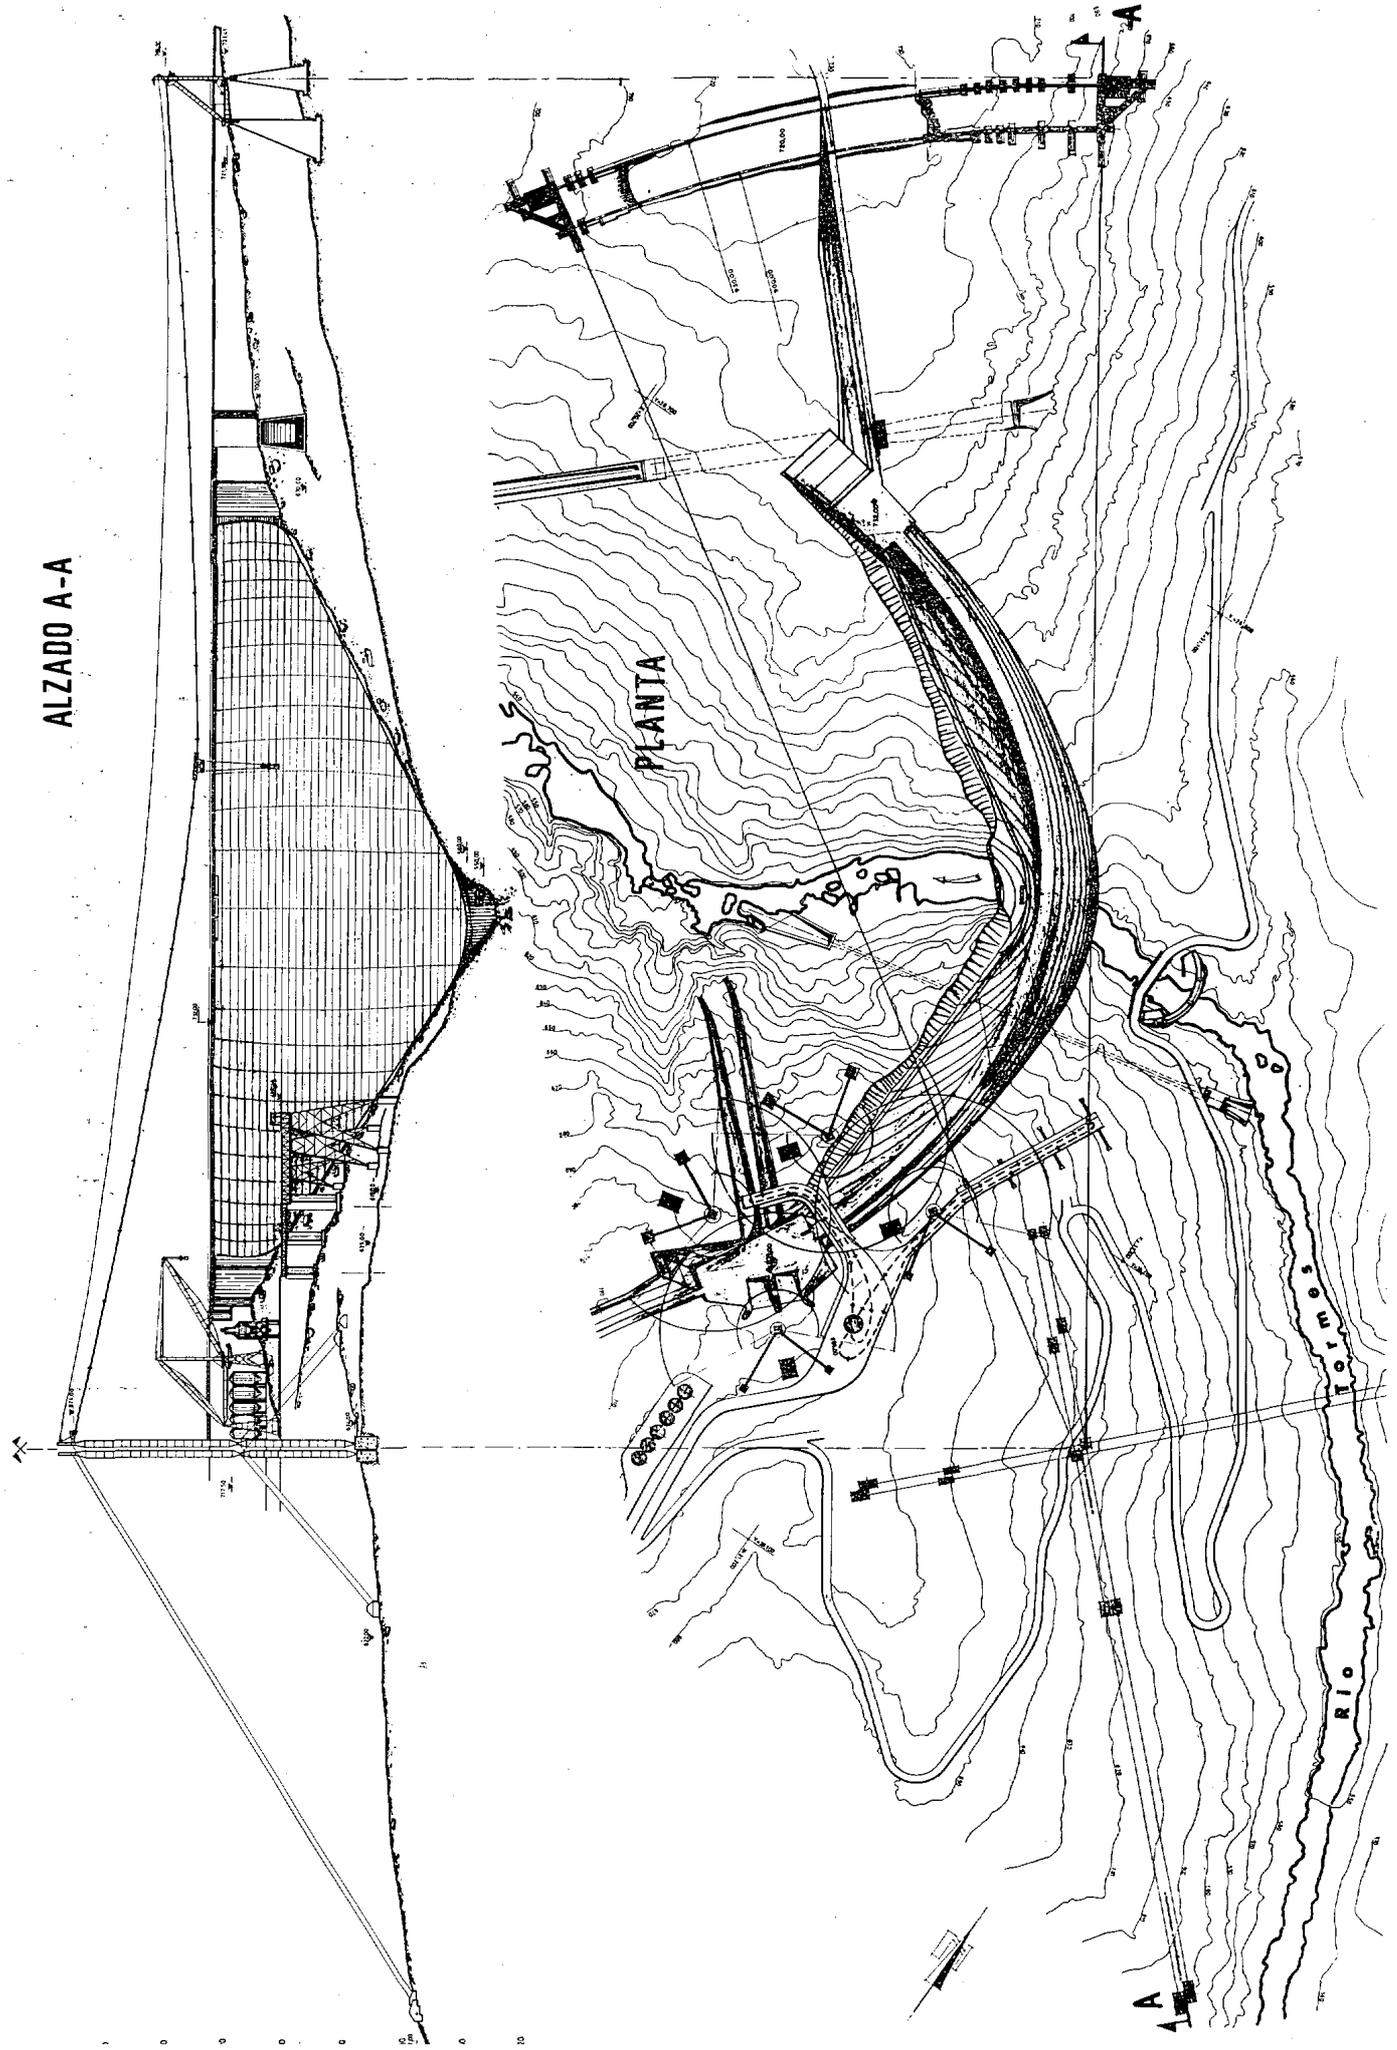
^a — Presa de Almendra, de IBERDUERO, S. A. Alzado y planta de las instalaciones de puesta en obra del hormigón en la bóveda y estribos.
